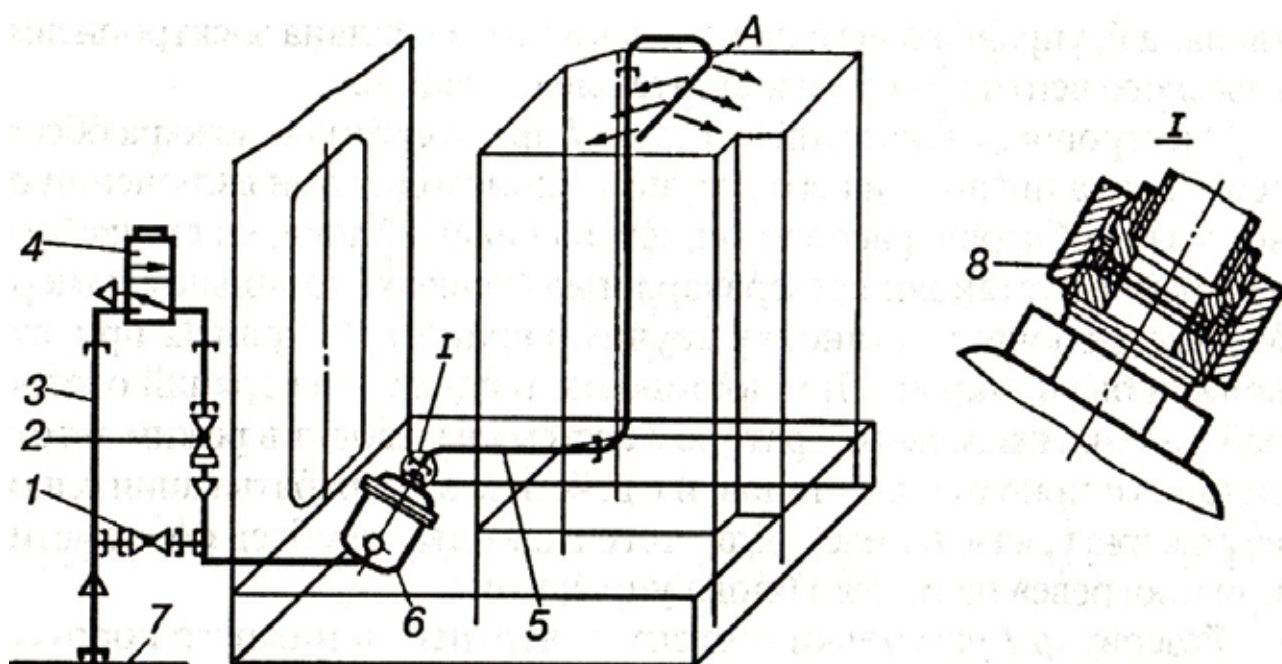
Схема установки порошкового пожаротушения высоковольтной камеры:
